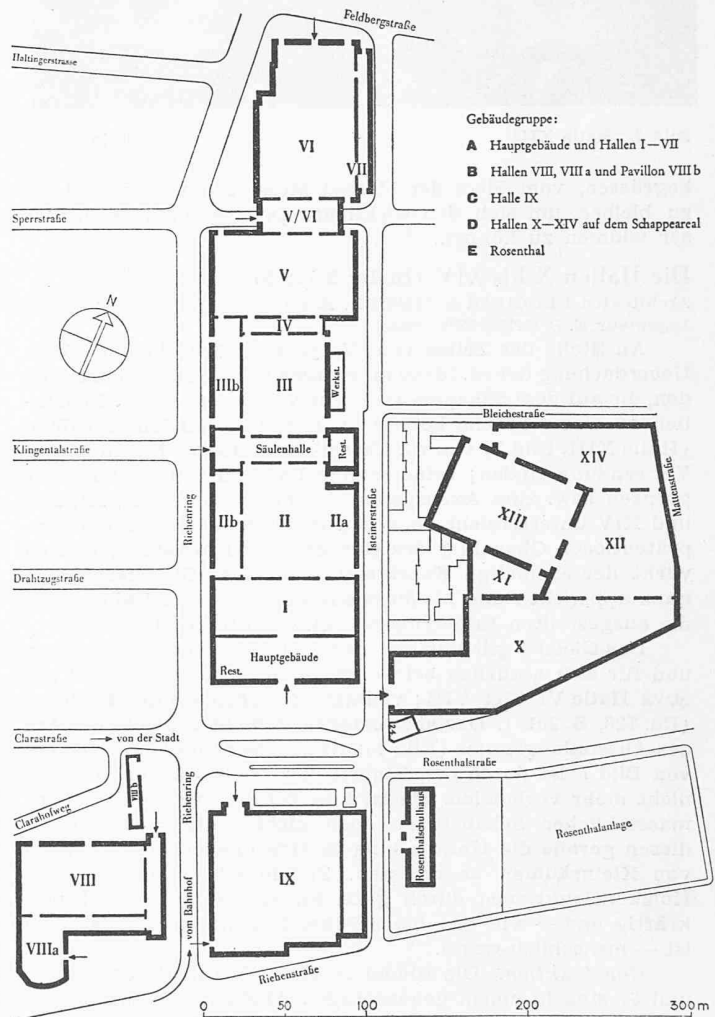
Lageplan der Mustermesse-Bauten in Basel, Masstab 1 : 4500
